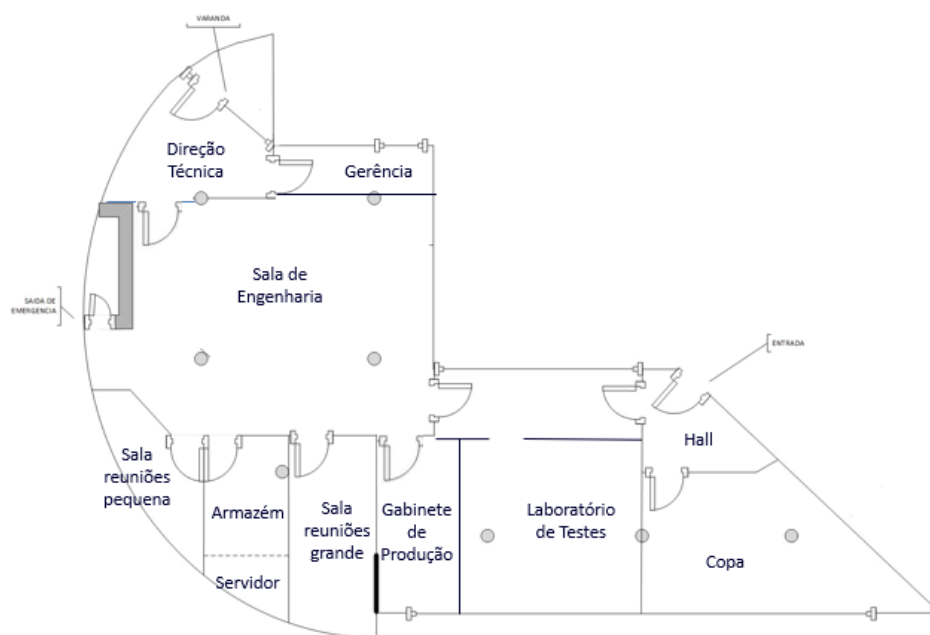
Planta do 1º Andar das instalações da empresa EVOLEO
